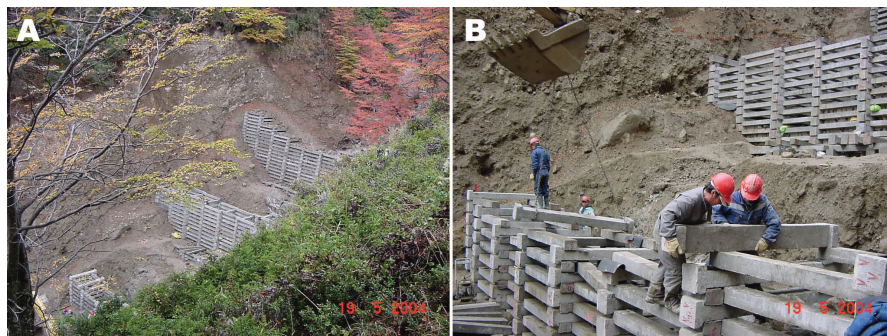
Construcción de los check-dams en la ciudad de Coyhaique. A) Series de check-dams en un canal de pendiente fuerte. B) Construcción de la presa. Estos check-dams están construidos en base a cajas hechas de vigas de concreto prefabricado rellenas con piedras obtenidas en el campo.
